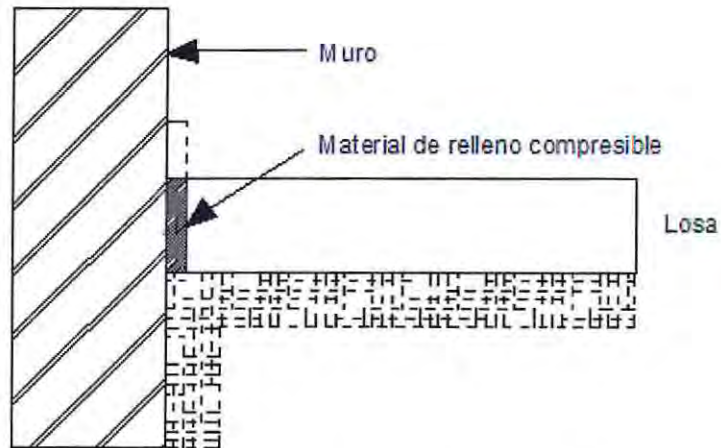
Junta de aislación en muro (ACI 360R-10).
